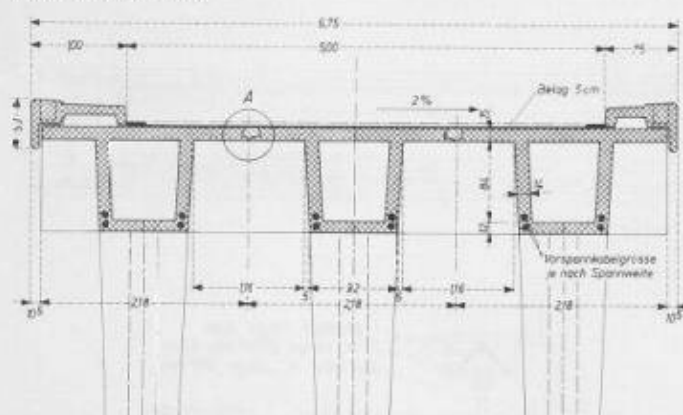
Voll vorfabrizierte Ueberführung, Querschnitt 1:80, Detail A: Fuge (Asymmetrie wegen Montage)
